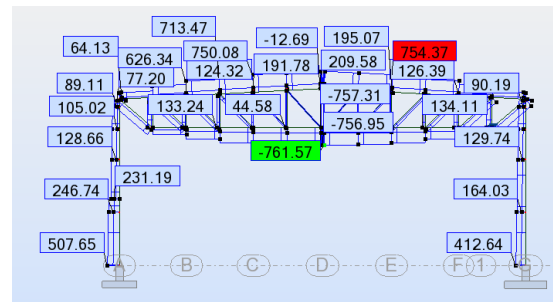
Schemat konstrukcyjny projektowanego obiektu w osi „4”.
